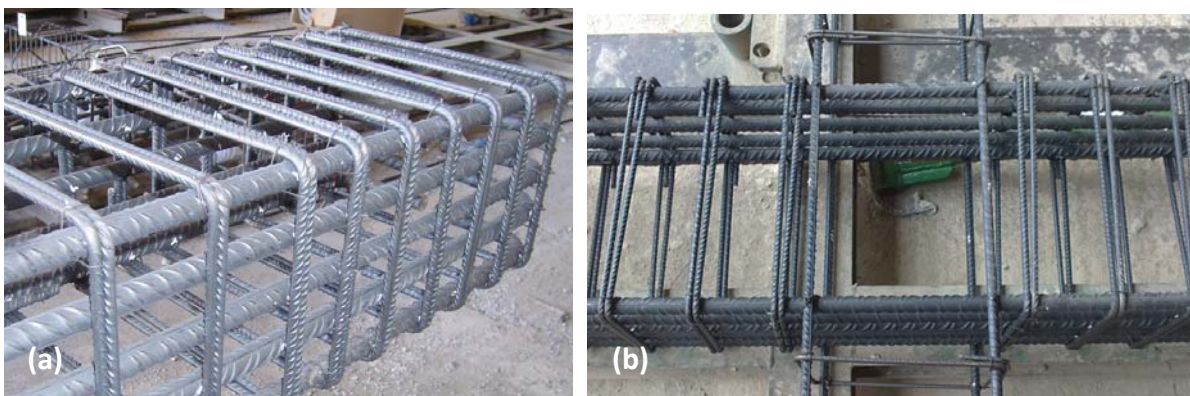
Fotografías del armado de la viga Tipo S. a) terminación en extremo, b) continuidad de armaduras en el nudo.
